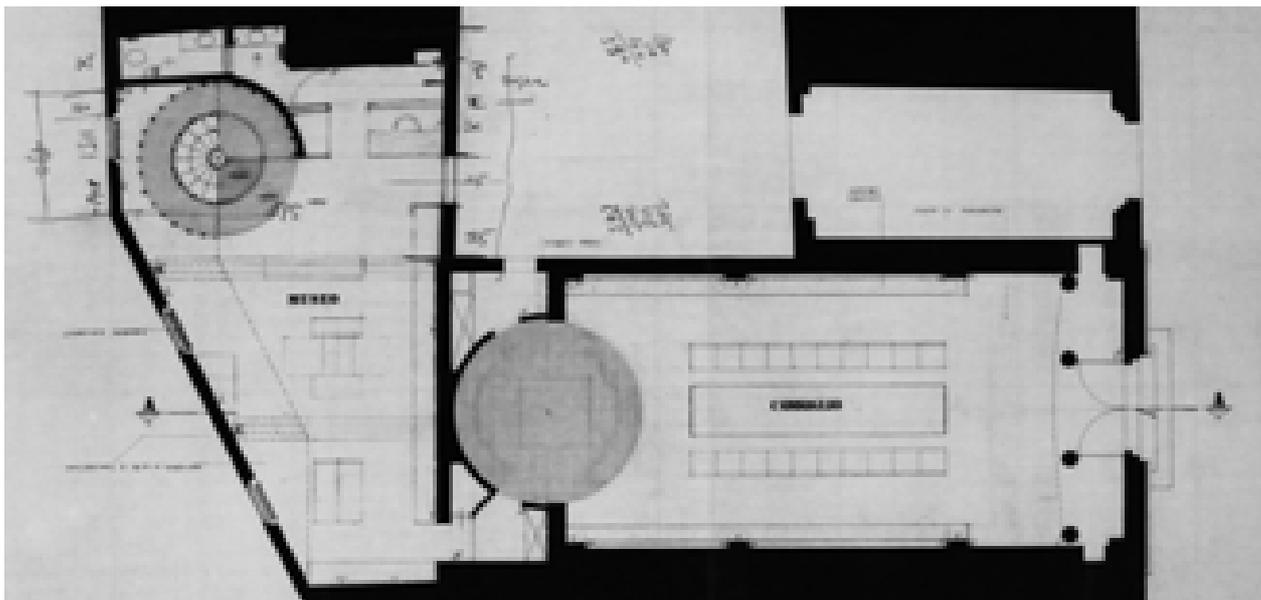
Pianta quota +0,00– Stato di progetto – 10/11/1980 (AABS-94.199)
